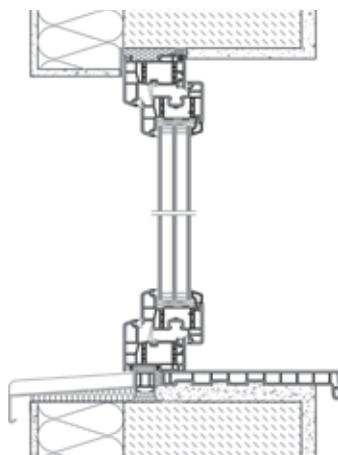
Fenster mauerwerksbündig nach außen eingebaut, geringe Wärmebrücken sind hier noch vorhanden
